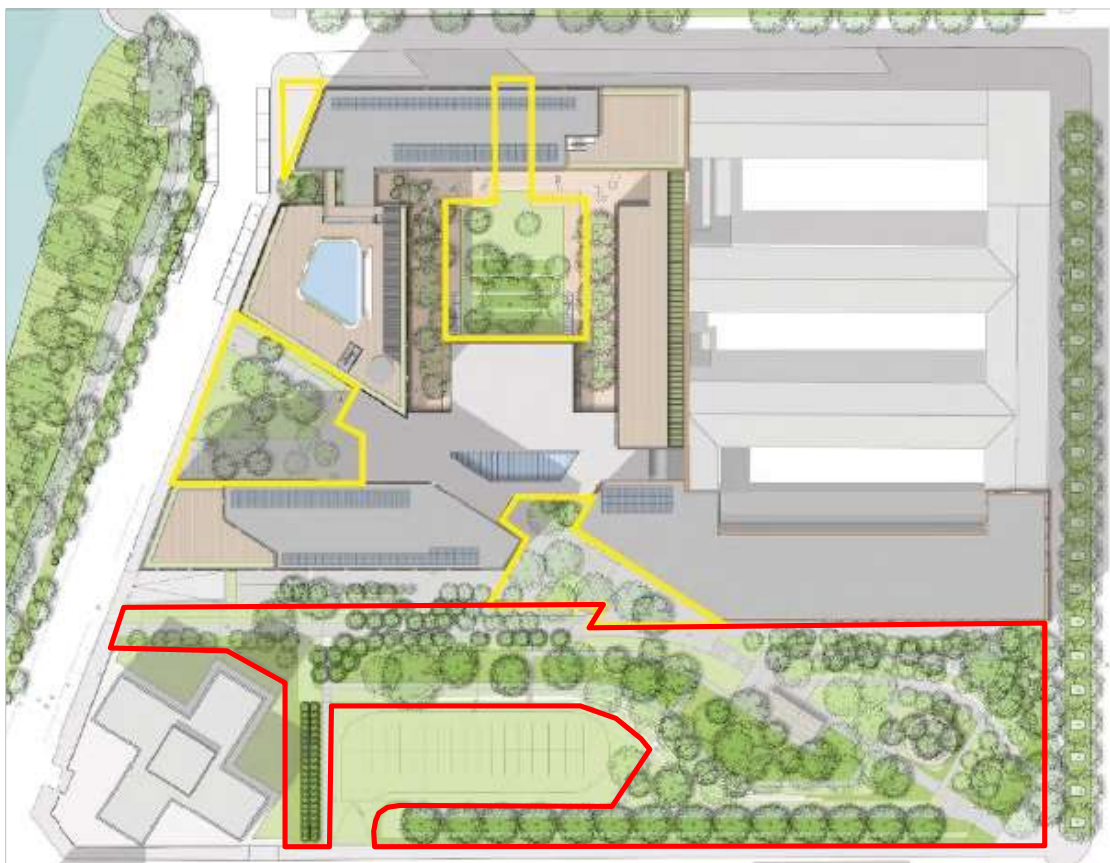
Planimetria Generale di Progetto con individuazione del Campus Urbano, del Parco Urbano (in rosso) e delle aree private in assoggettamento ad uso pubblico (in giallo)
